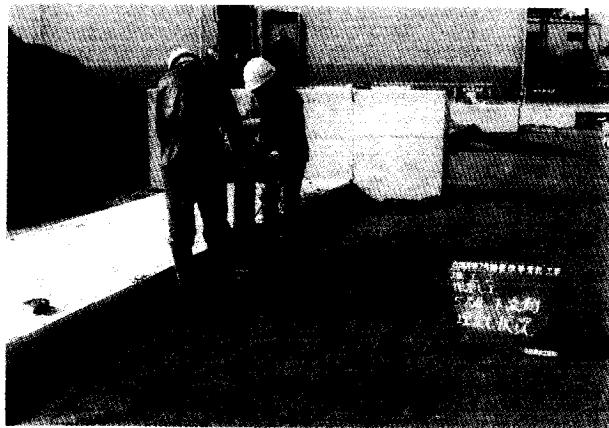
タンパによる構造物周辺の埋戻し、転圧状況
